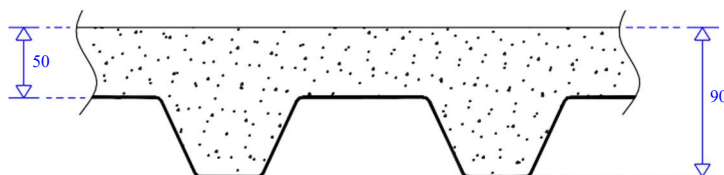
Espessuras mínimas [mm] da secção transversal de uma laje mista com funções de diafragma.
